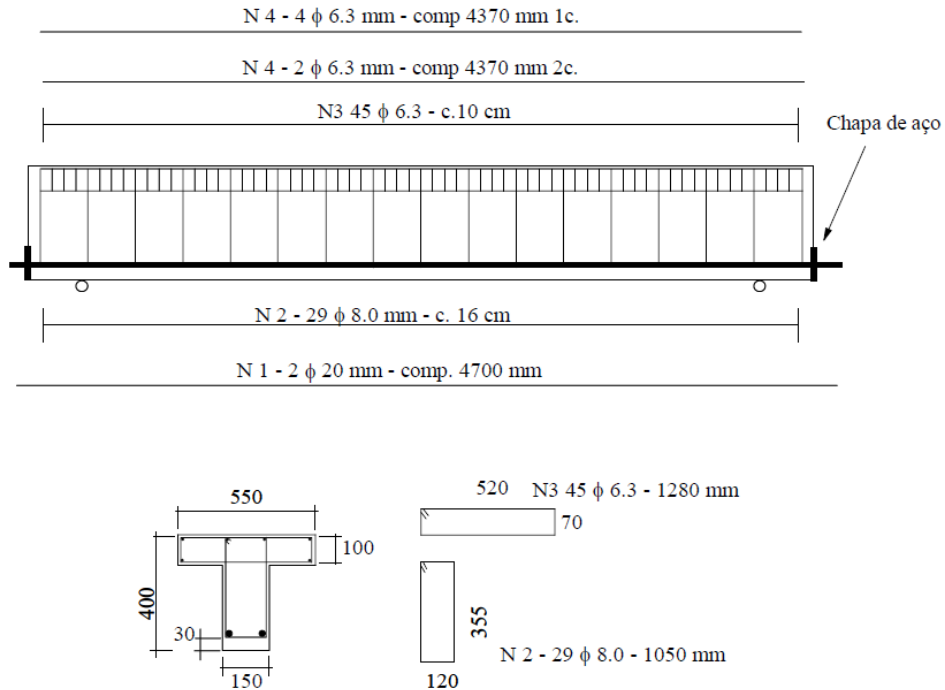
Detalhe das dimensões e armadura das vigas da série I (Castro, 2004)
